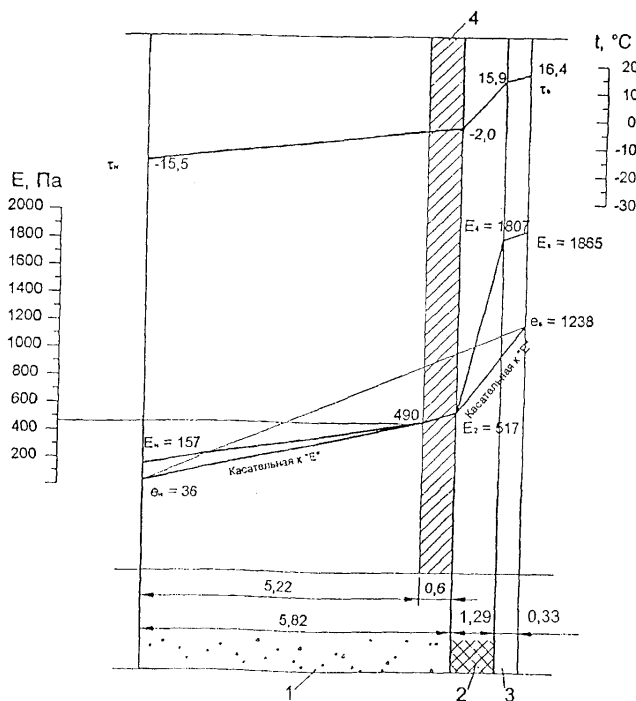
Зона конденсации влаги в стене подвала, утепленной со стороны помещения
